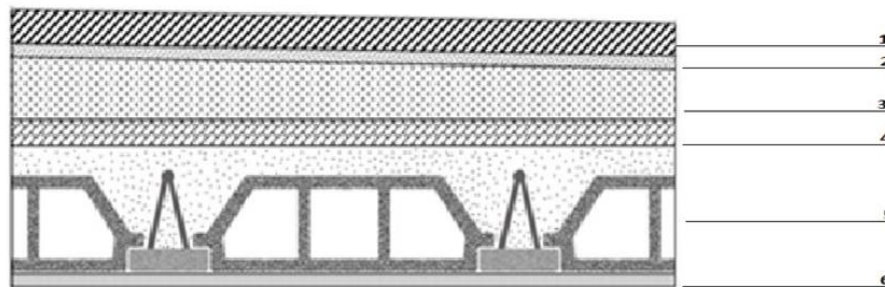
Coupe verticale du plancher terrasse à corps creux.
